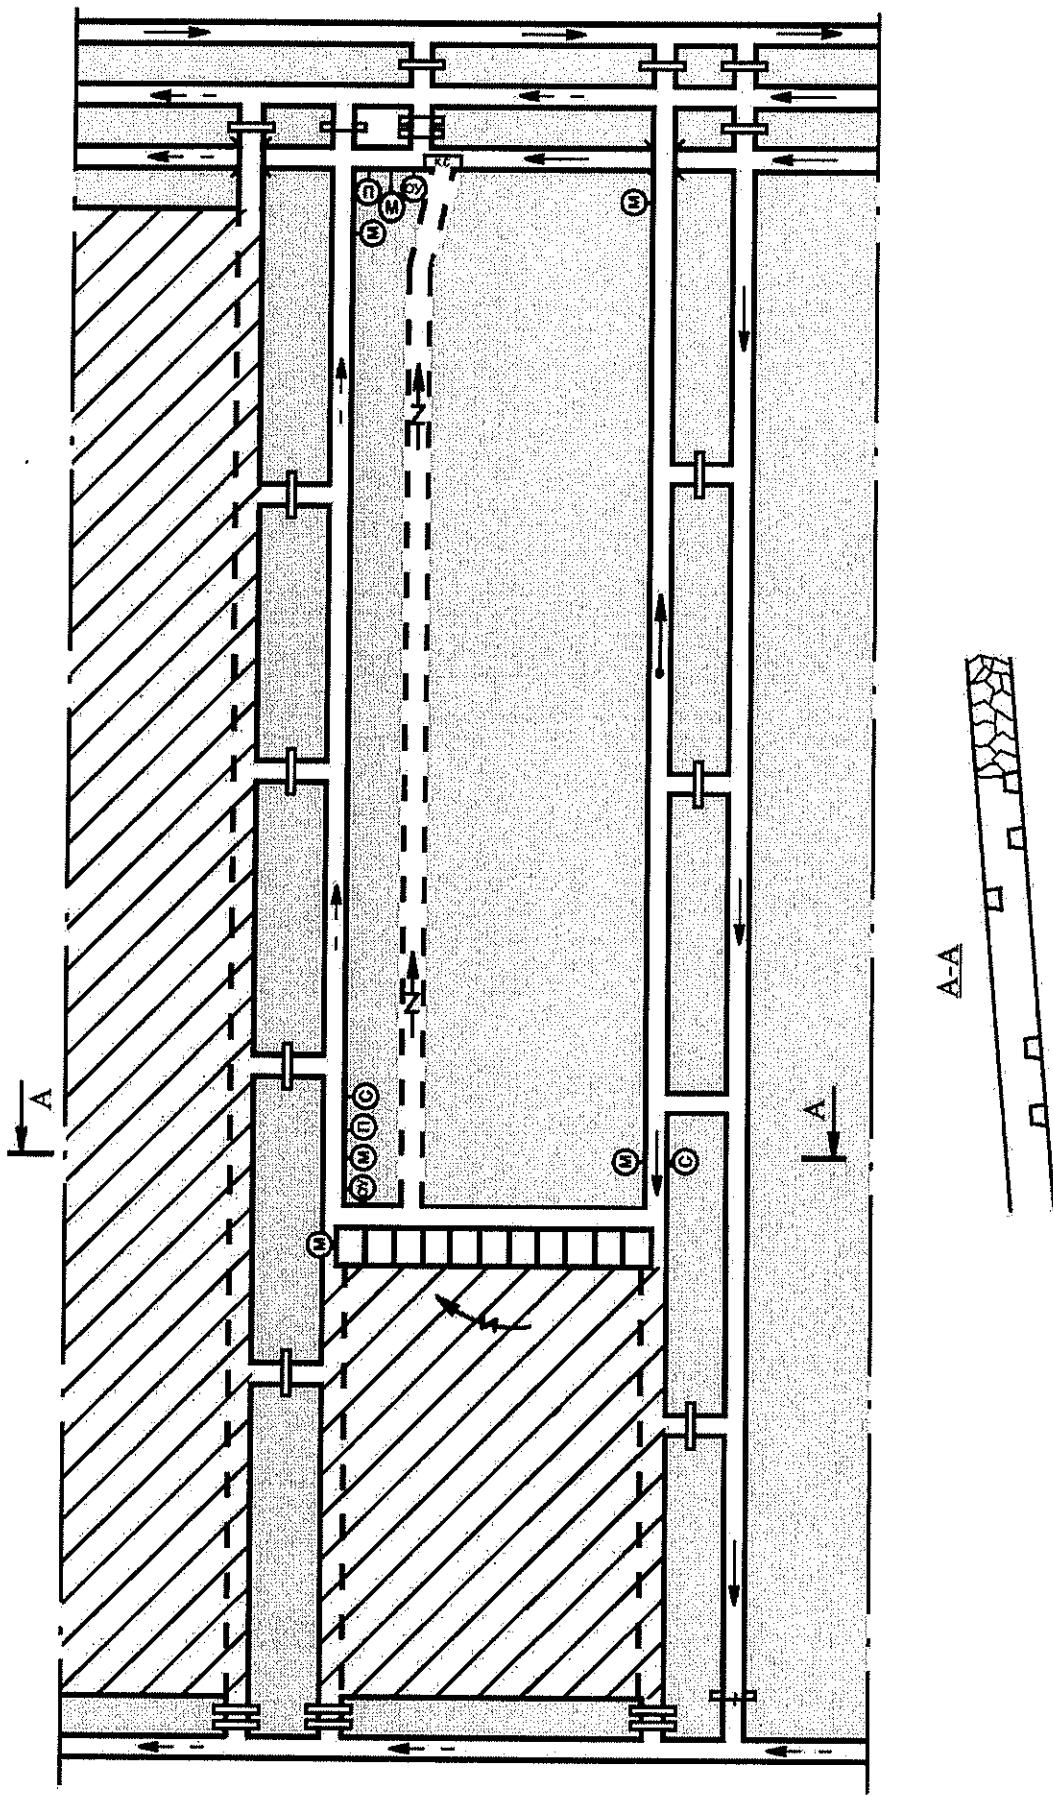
Схема проветривания выемочного ствола с отводом метановоздушной смеси по выработанному пространству и дренажной выработке, пройденной по верхнему слою, для схем отработки пластов с выпуском подкровельной пачки угля
